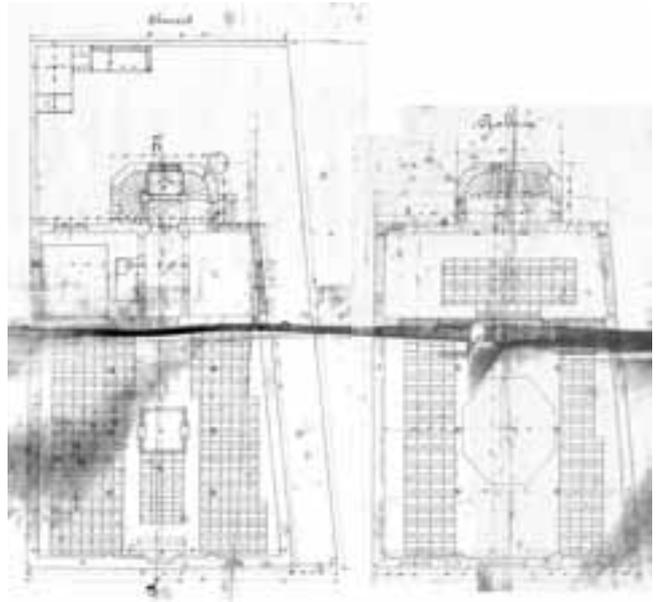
Die Grundrisse von Erdgeschoß und Obergeschoß, Jüdisches Museum Wien
